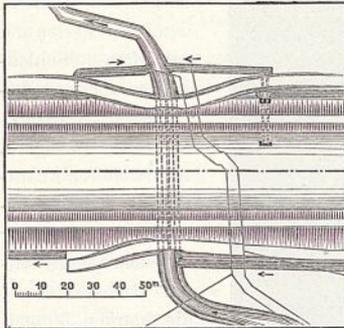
Lageplan des Landwehrbach-Dükers und Auslasses.
